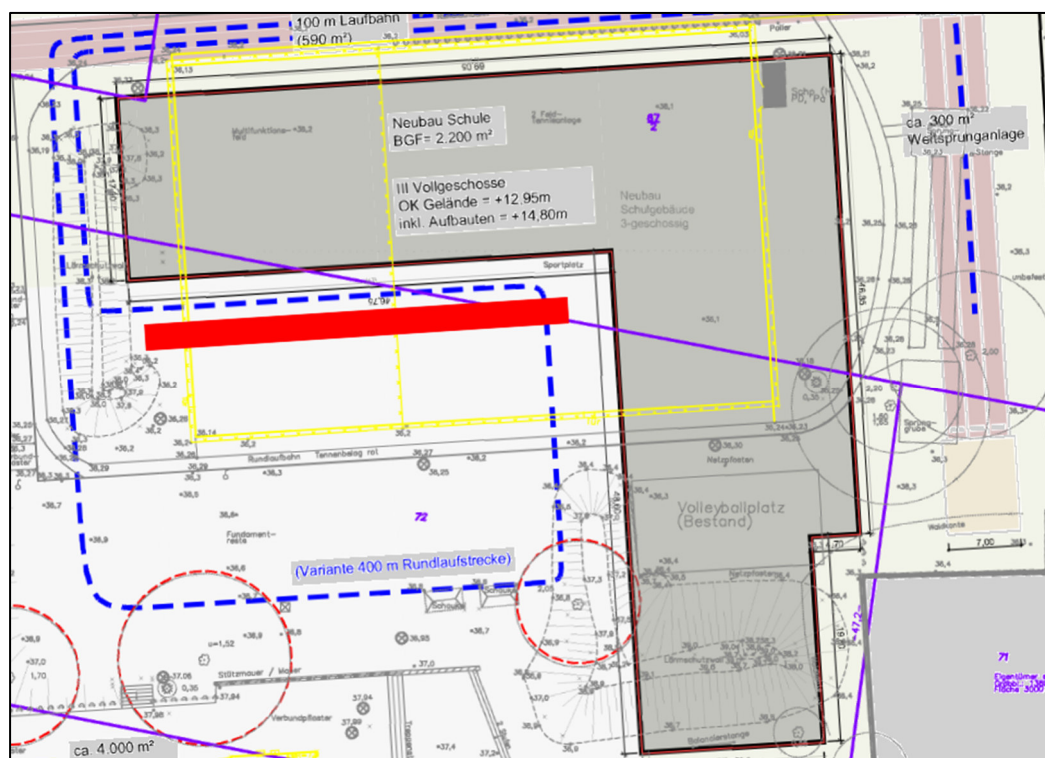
Lage Rigole Dachflächen – Neubau Schule Außenanlagenplanung Variante 2
